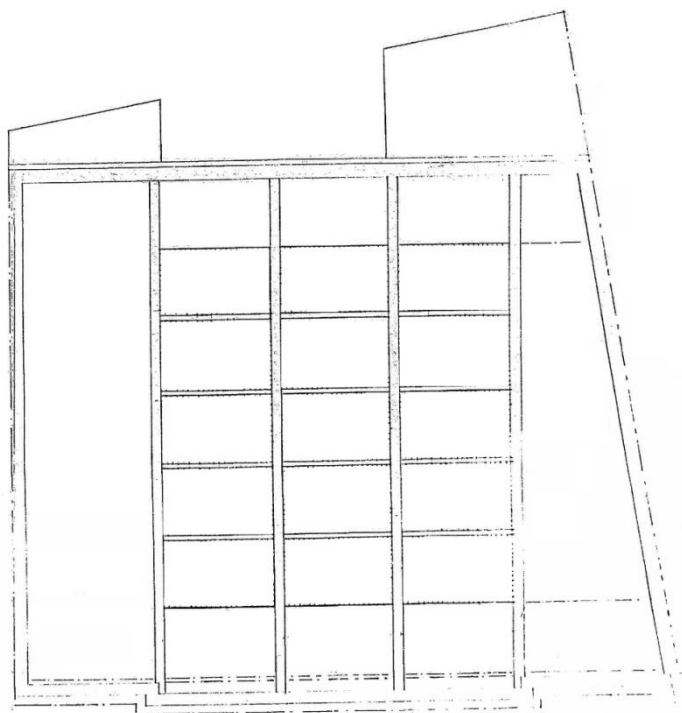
Planta da cobertura da Lota do Frigorífico do Peixe
